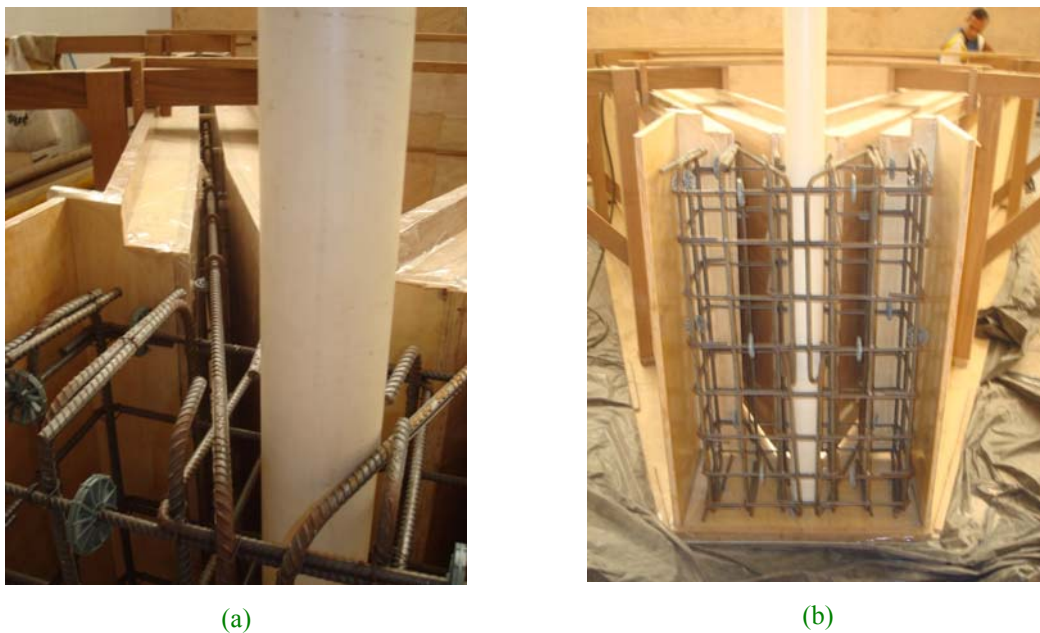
(a) Detalhe da armação (ancorada no núcleo central) do trecho inicial da alma. (b) Detalhe das barras de aço posicionadas no núcleo central.
